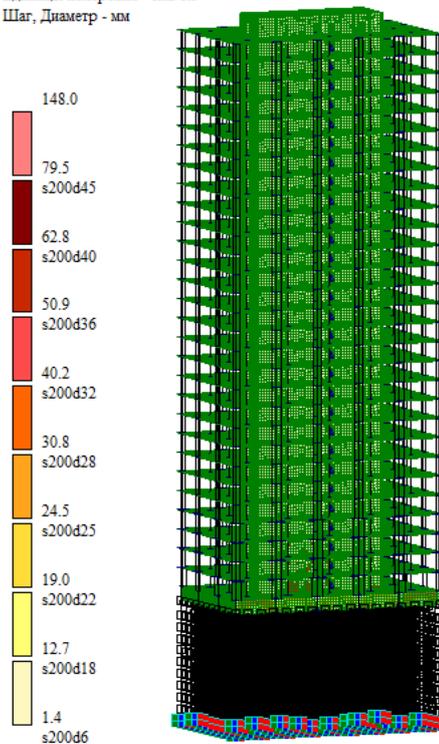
Схема армирования внутренней части стен по оси OX
